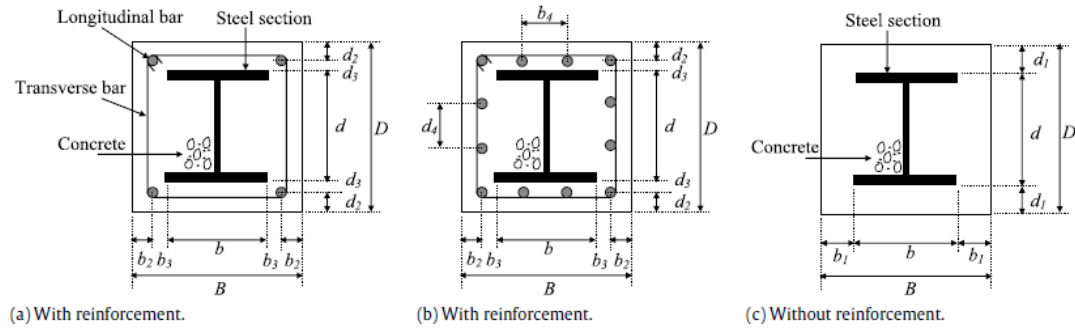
Tipos de secciones transversales verificadas (Ellobody, 2010a).
